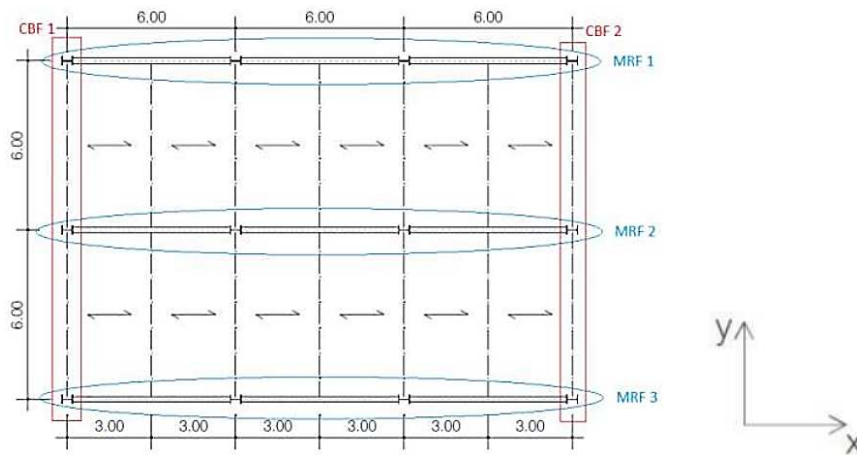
Planta do edifício (Fonte: Lopes, 2011)
